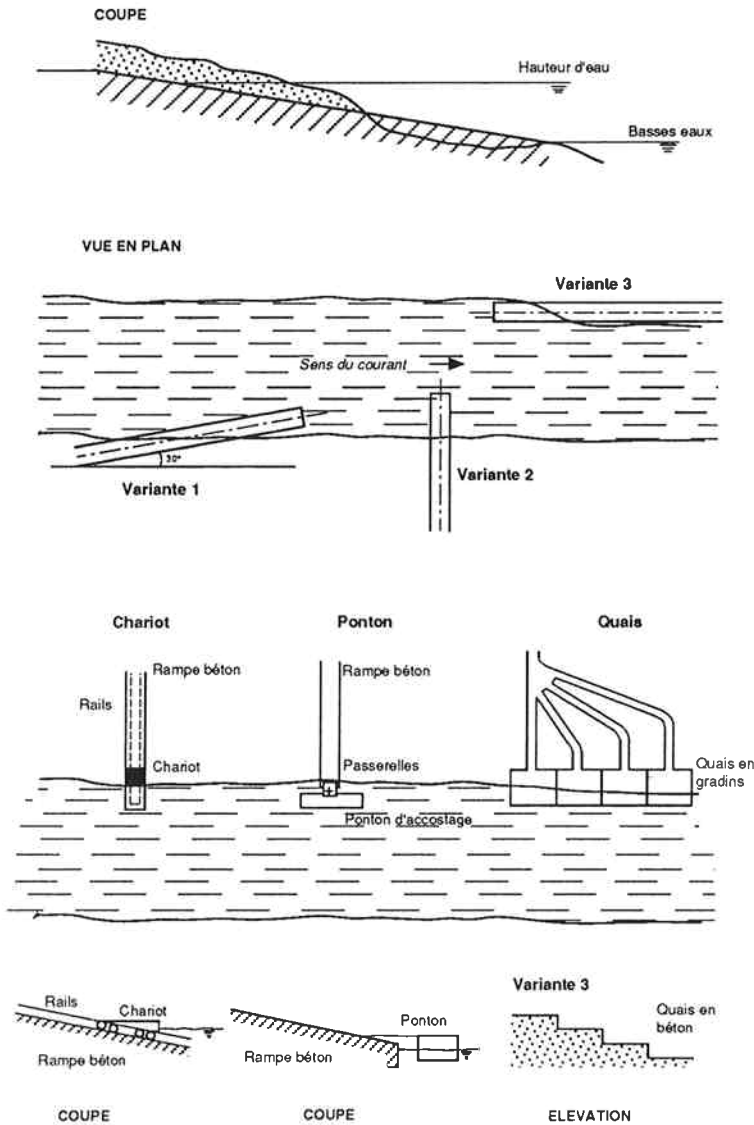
Divers types d'ouvrages d'accès au bac
